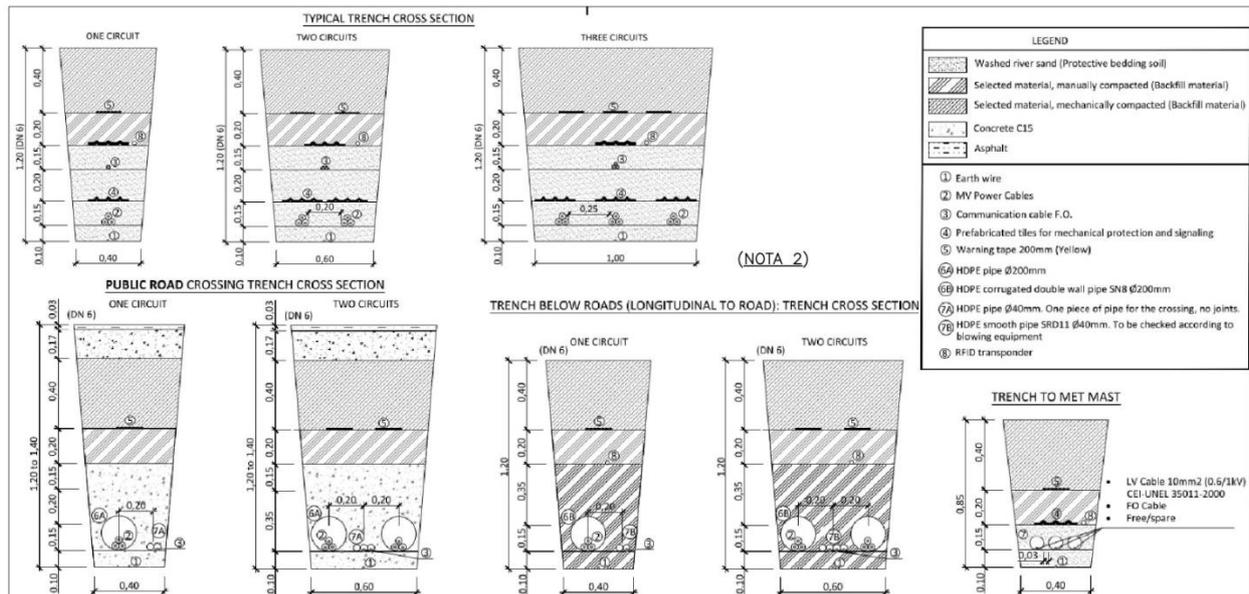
Tipici di posa cavidotto su sterrato e su pavimentazione in conglomerato bituminoso in tratta 30kV
